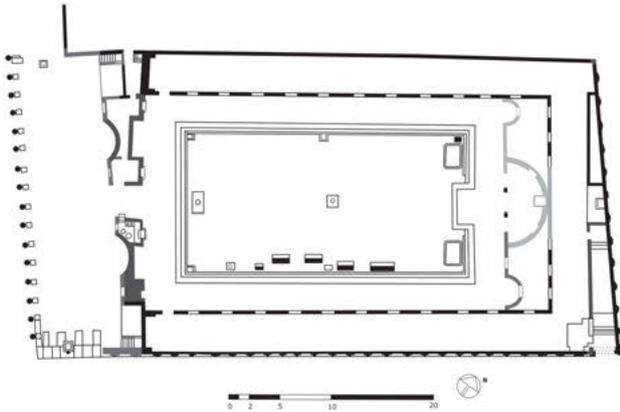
Gebäude der Eumachia, Grundriss
